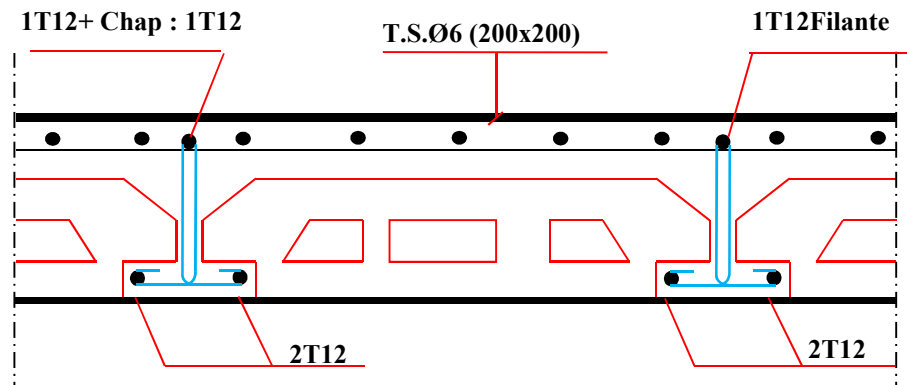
SCHEMA DE FERRAILLAGE DES POUTRELLES
